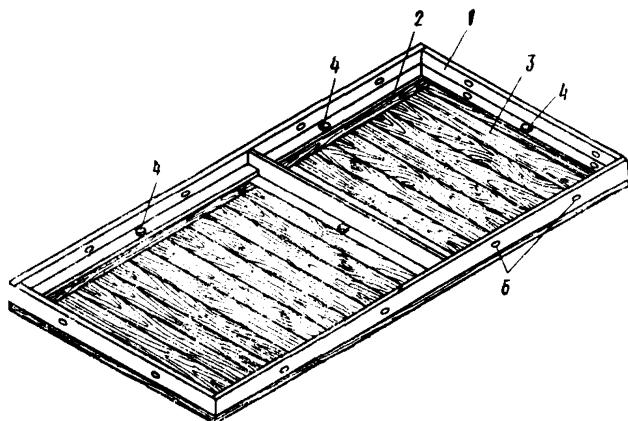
Общий вид комбинированного щита конструкции Тагилстрой
